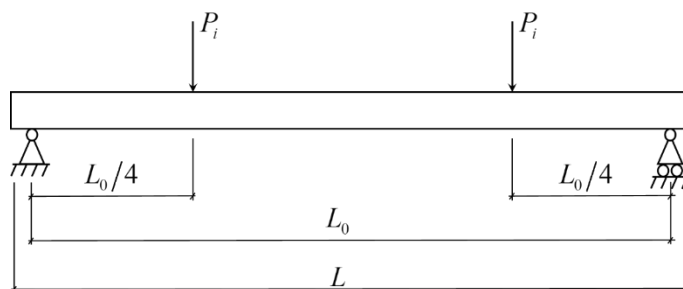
Расчетная схема балки 1 ПБ-10-1П
